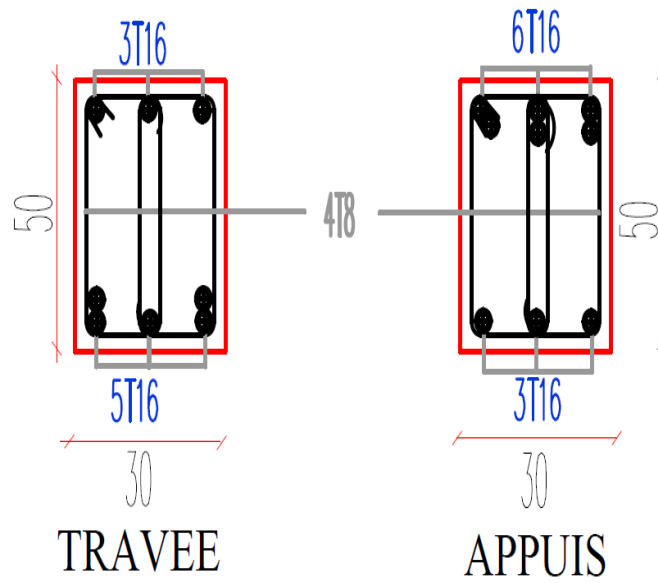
Schéma de ferrailage des poutres principales de la terrasse.
